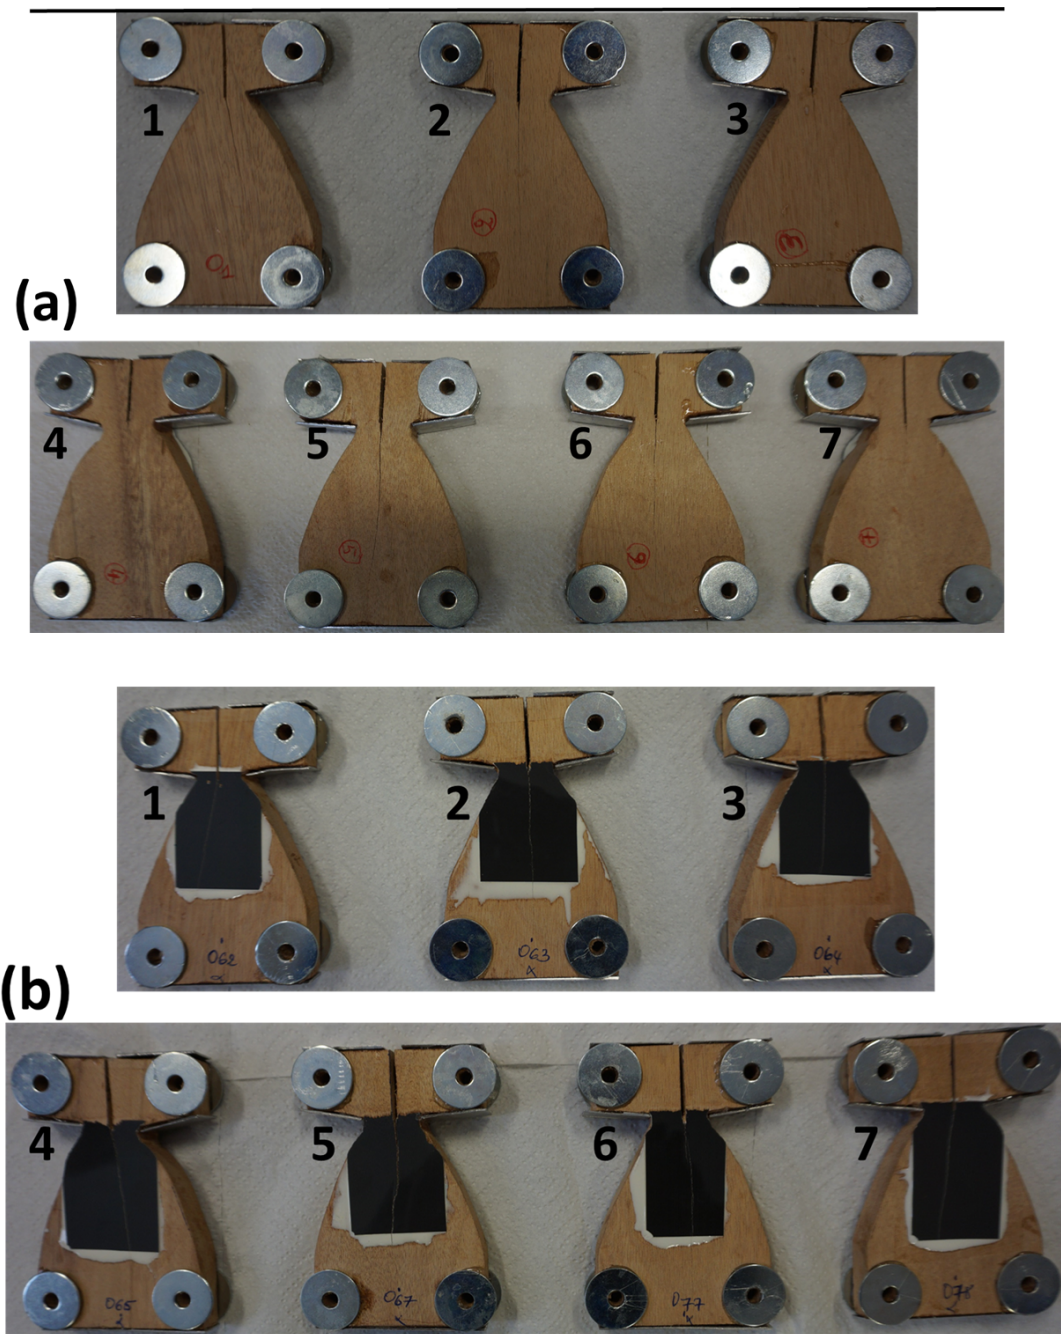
Exemples d'éprouvettes d'okoumé : face sans grille (a) et face avec grille (b)
